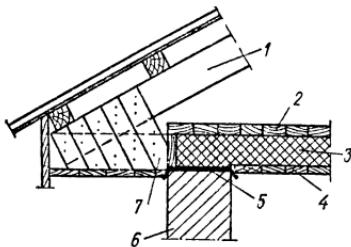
Фрагмент междуэтажного перекрытия, устраиваемого в плоскости нижнего пояса стропильных ферм
